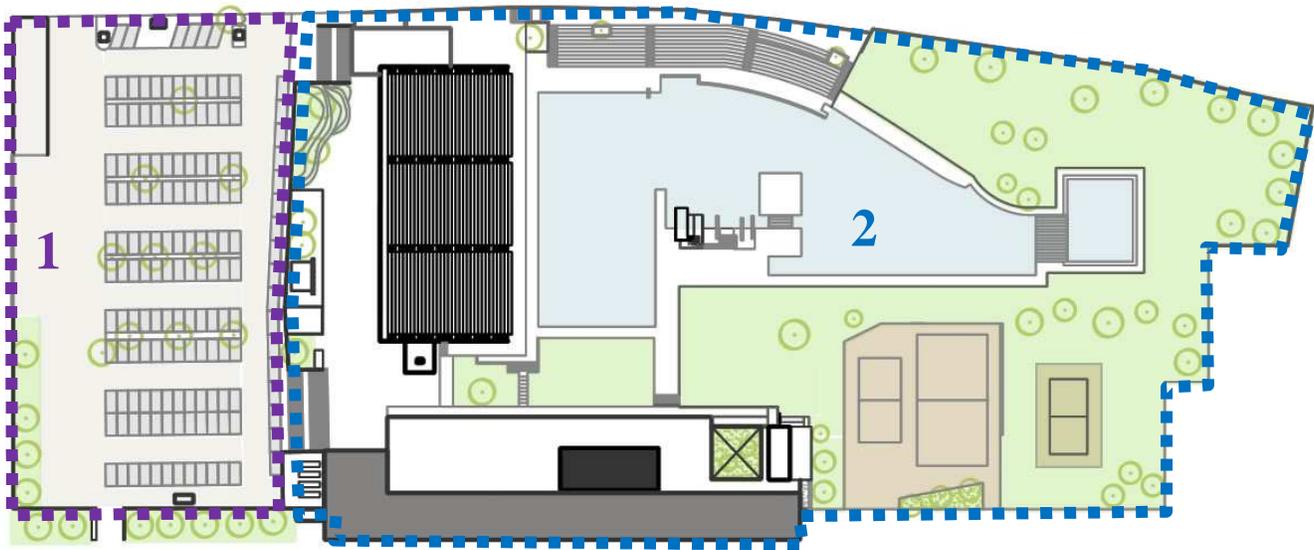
Alberca Olímpica Universitaria. Planta de conjunto
